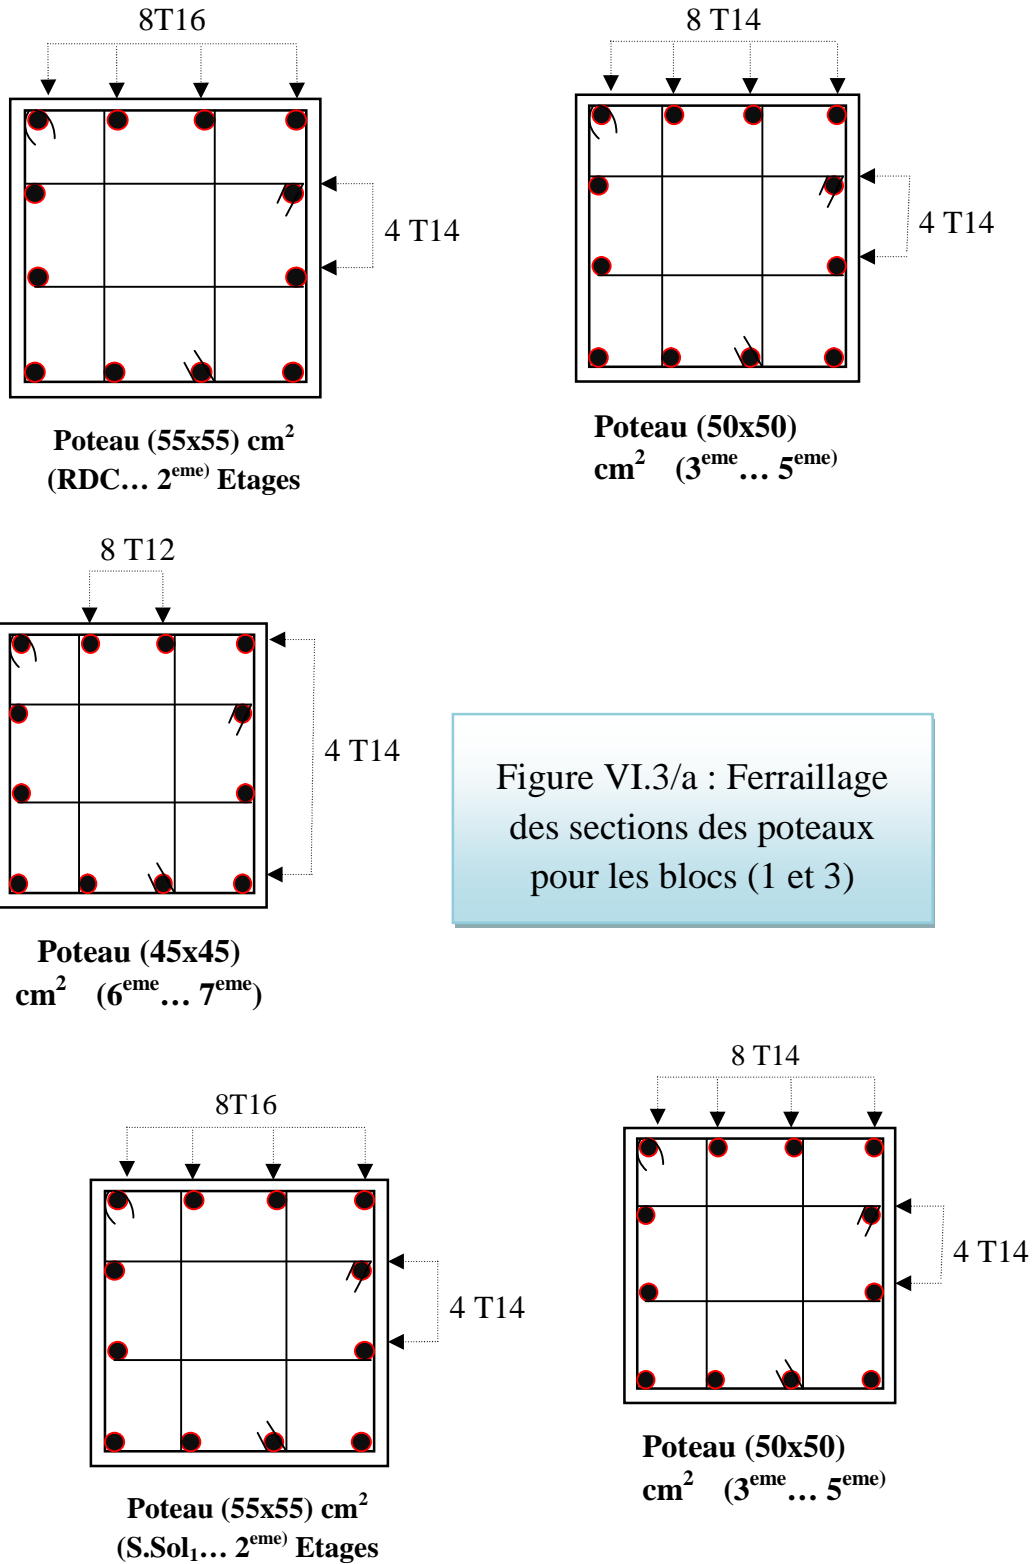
/a : Ferrailage des sections des poteaux pour les blocs (1 et 3)
